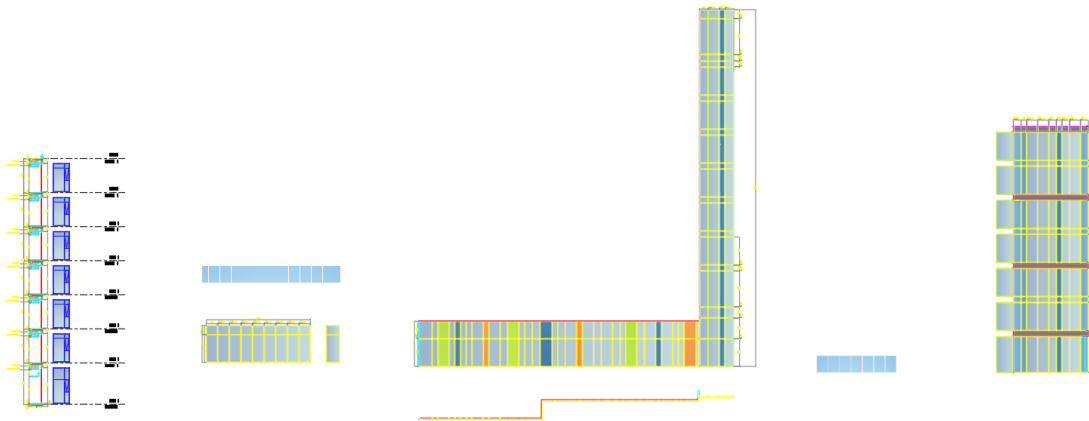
Detalles DWG de ventanería Hotel Courtyard
